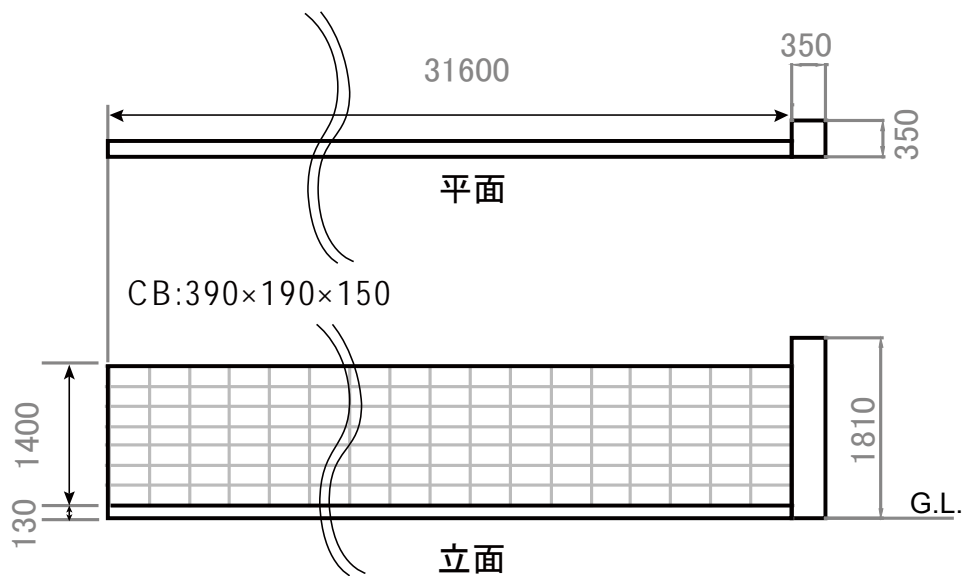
TK 工業株式会社前の CB 塀 立面・平面図 (単位: mm)
